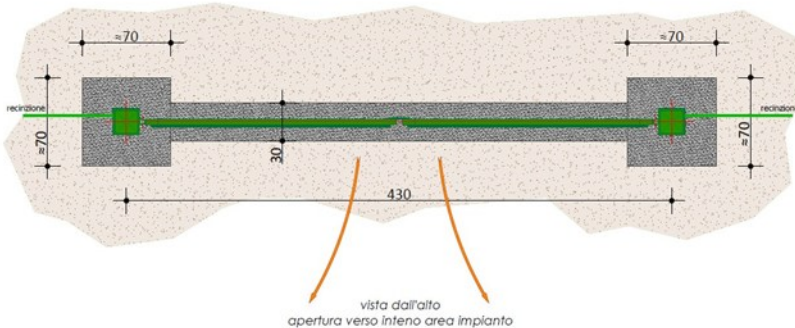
Disegno del prospetto della recinzione perimetrale di cantiere.
